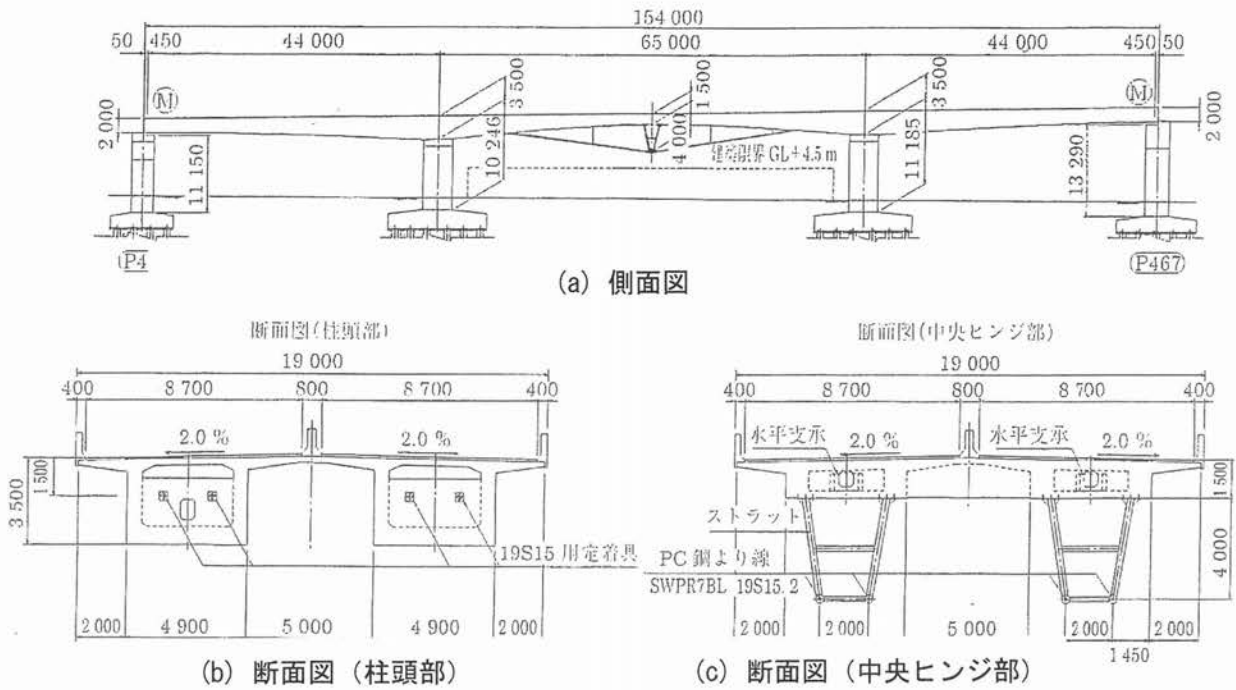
喜連瓜破高架橋の一般図(寸法単位: mm)
